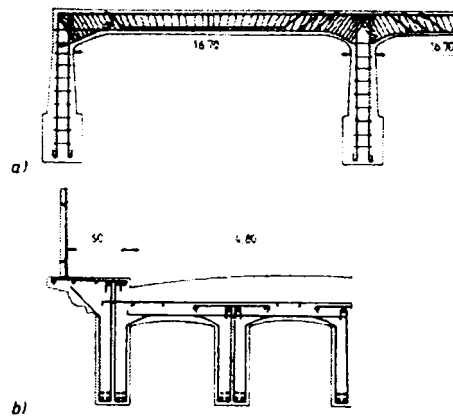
Armarea podului peste râul Bela Reka. Secțiune longitudinală (a) și secțiune transversală (b).
